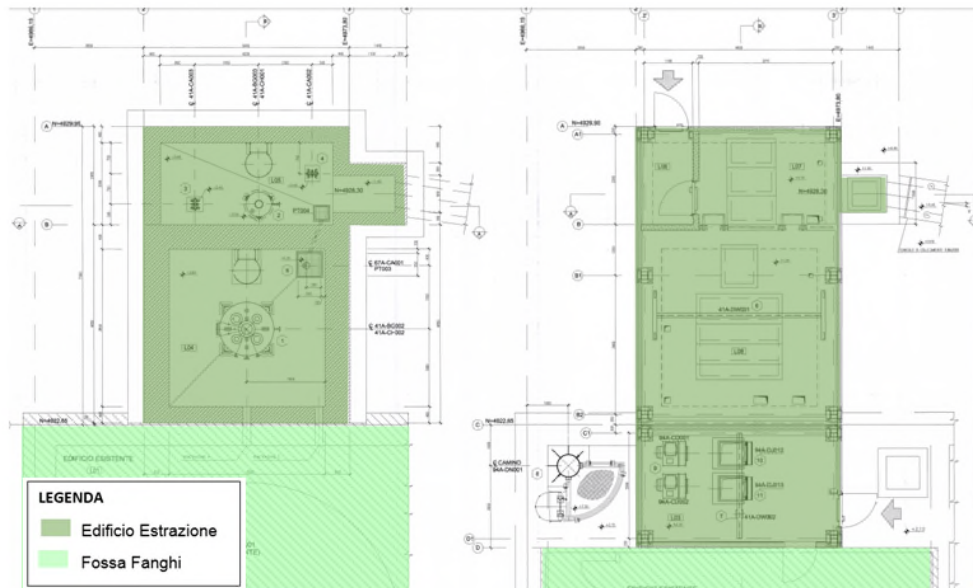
Edificio di Estrazione – Pianta piano interrato e Pianta piano campagna
